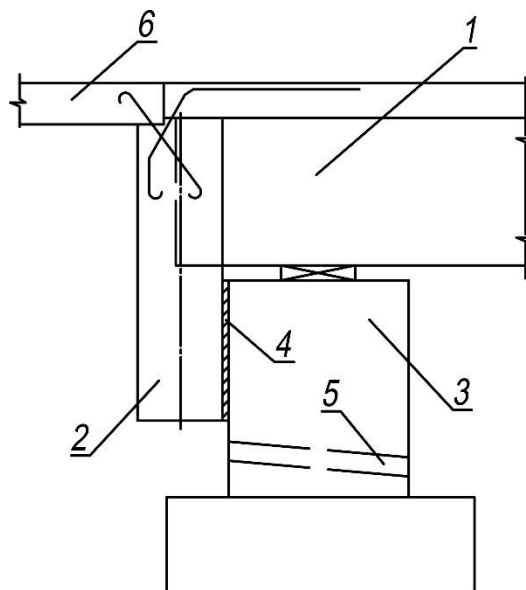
Полуинтегральный устой: 1 – балка пролетного строения; 2- стенка-диафрагма; 3 - тело устоя; 4 – уплотнитель; 5 – дренажное отверстие; 6 – переходная плита
